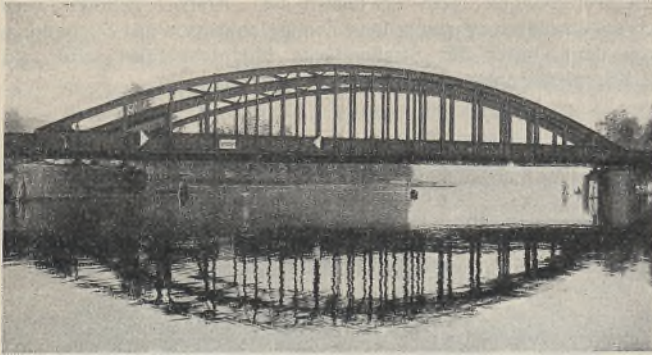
Eisenbahnbrücke über die Havel bei Potsdam.
